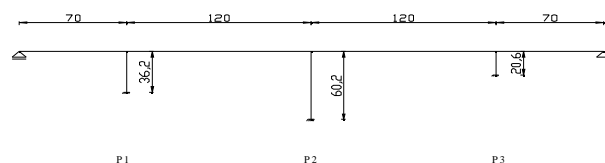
Esquema estrutural da ponte (alçado).
